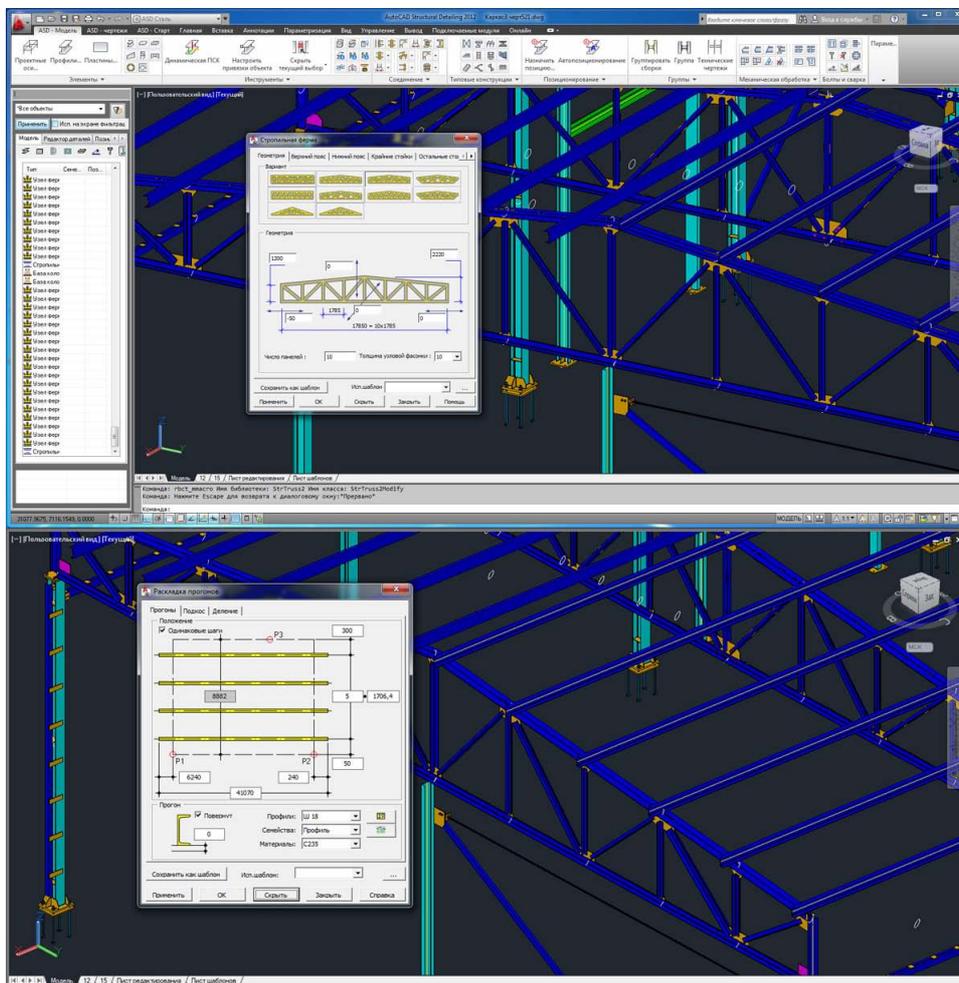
Проектирование стропильной фермы и раскладка кровельных прогонов.
